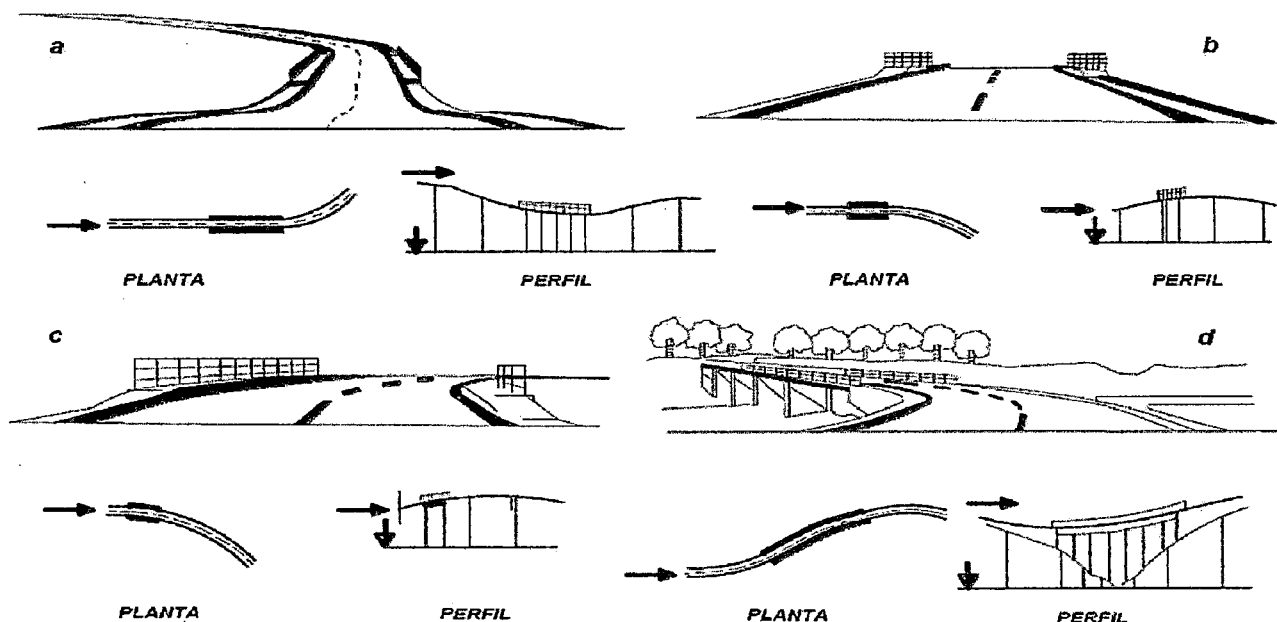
Coordinación del trazo en planta y perfil en estructuras - Fuente[2]
